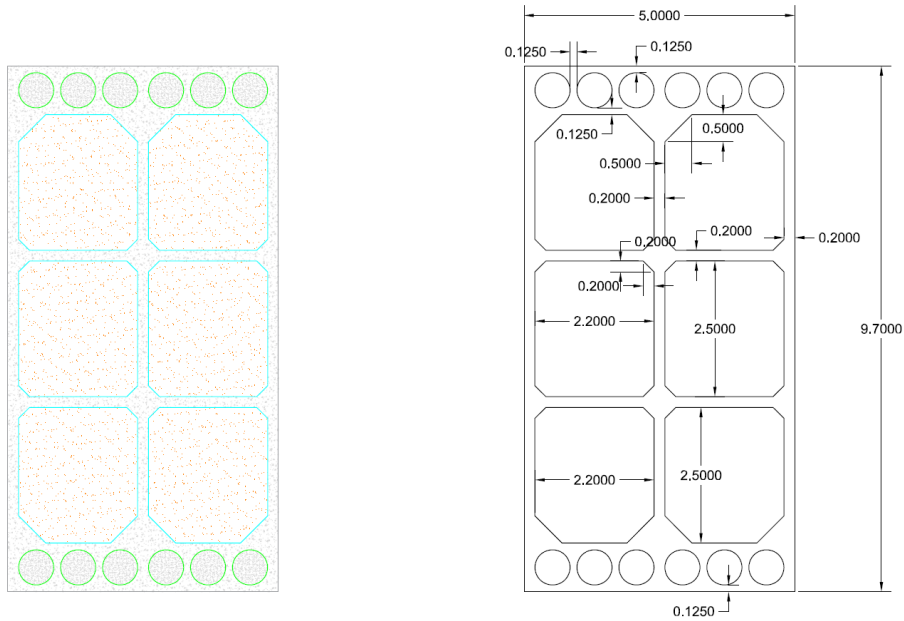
Estimación geometría del bloque prefabricado existente. Pilas P1 y P6.
